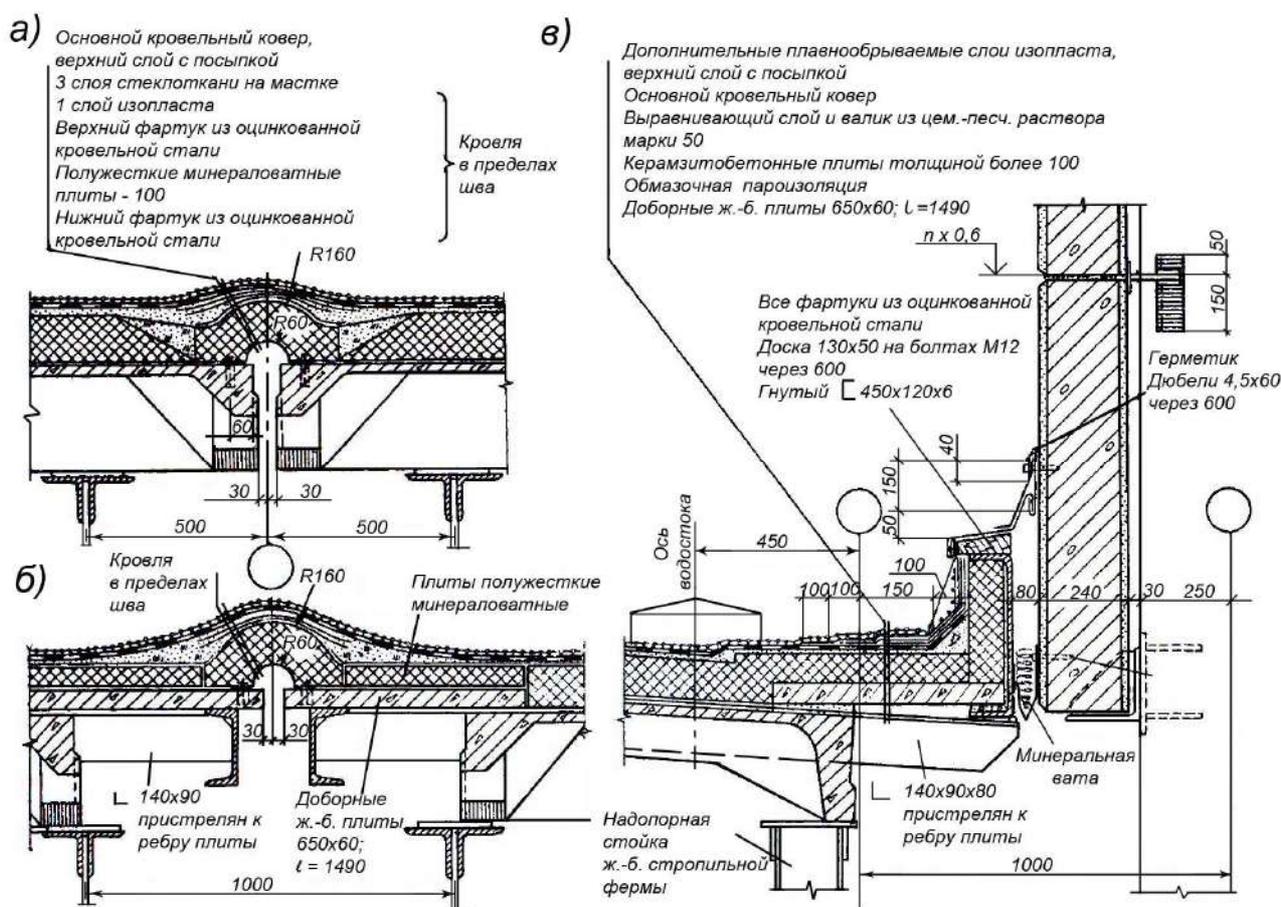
Кровли по настилу из железобетонных плит. Конструкции деформационных швов в покрытии:
